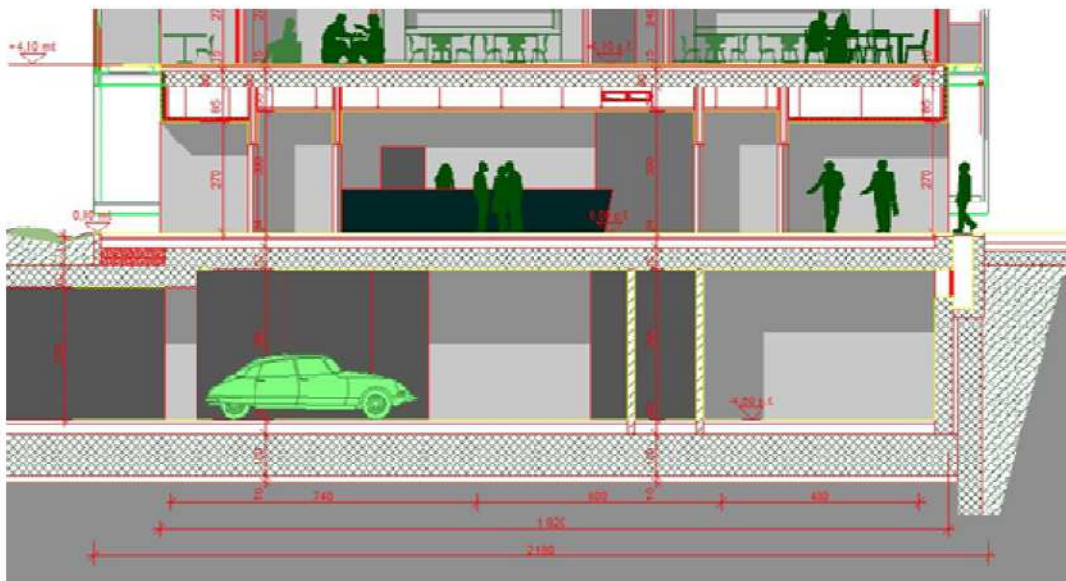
Dettaglio della sezione degli interrati del nuovo edificio.
